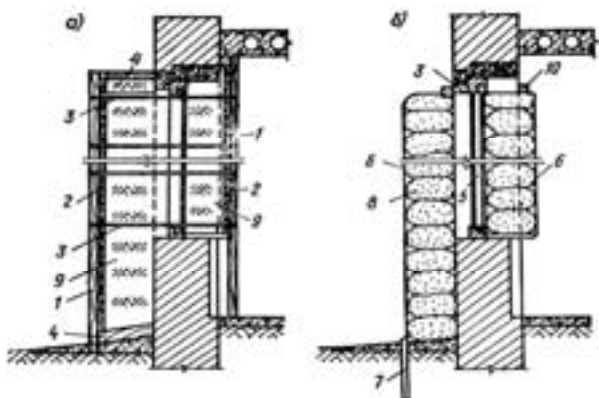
Підвищення захисних властивостей зовнішніх стін у місцях розташування віконних прорізів: а) ґрунтом; б) мішками з ґрунтом; 1 – брус дерев'яний; 2 – дошки; 3 – скрутки з дроту; 4 – розпірка; 5 – віконний блок.
